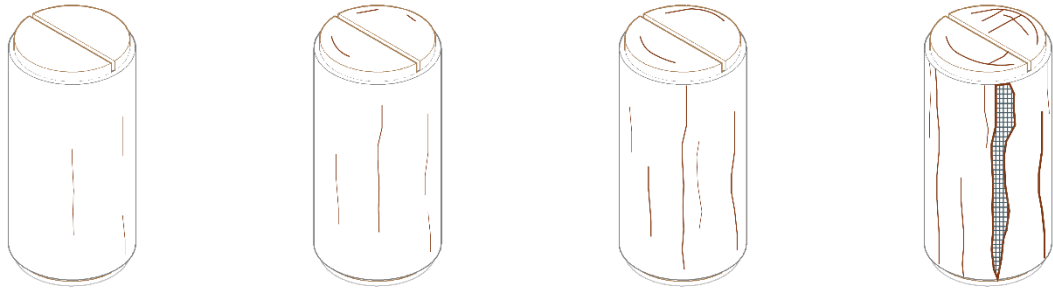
schema del quadro fessurativo previsto in prospetto per colonne a base circolare (CI FRCM)
